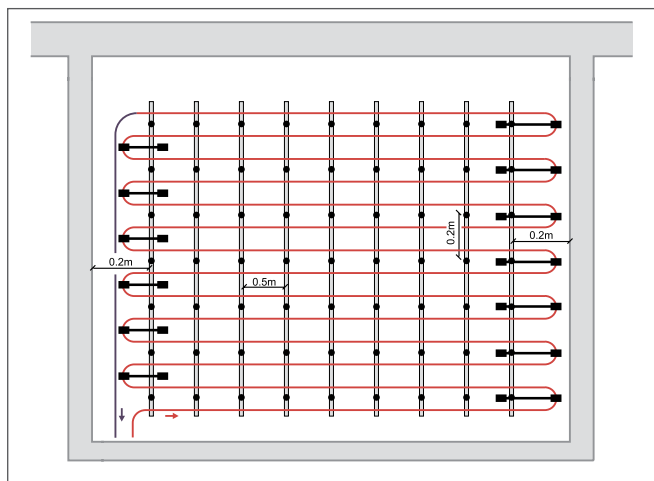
Plan de pozare meandru simplă, pas de pozare 10 (vedere dinspre perete)
